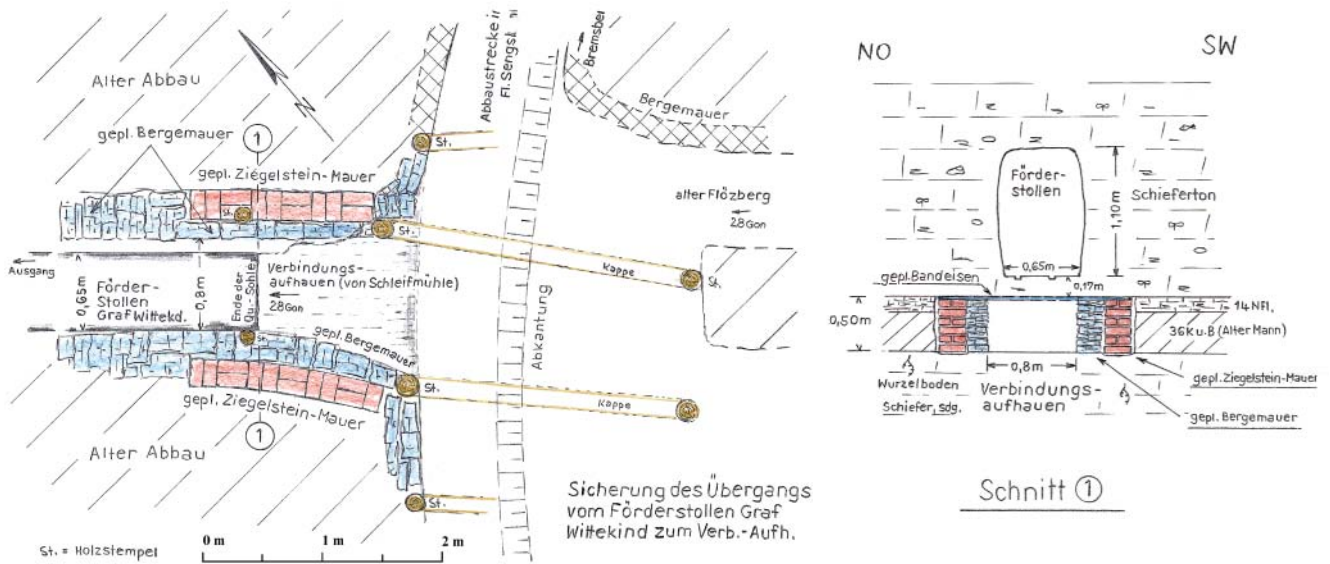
Plan der Sicherung des Übergangs Verbindungsaufhauen/Förderstollen Graf Wittekind (Grundriss u. Schnitt)
